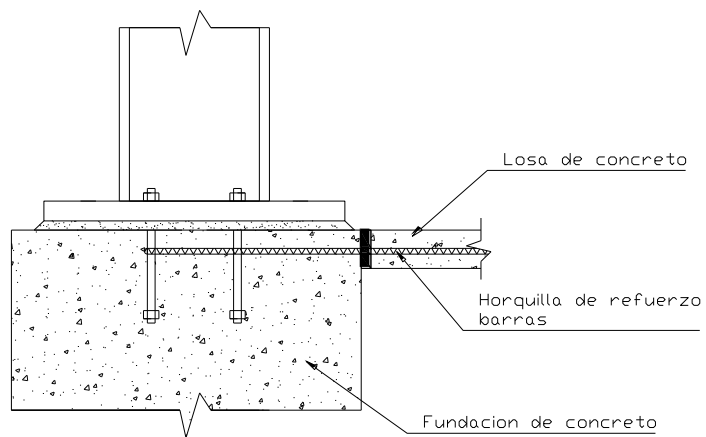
Detalle Típico Usando Barras Horquillas.
